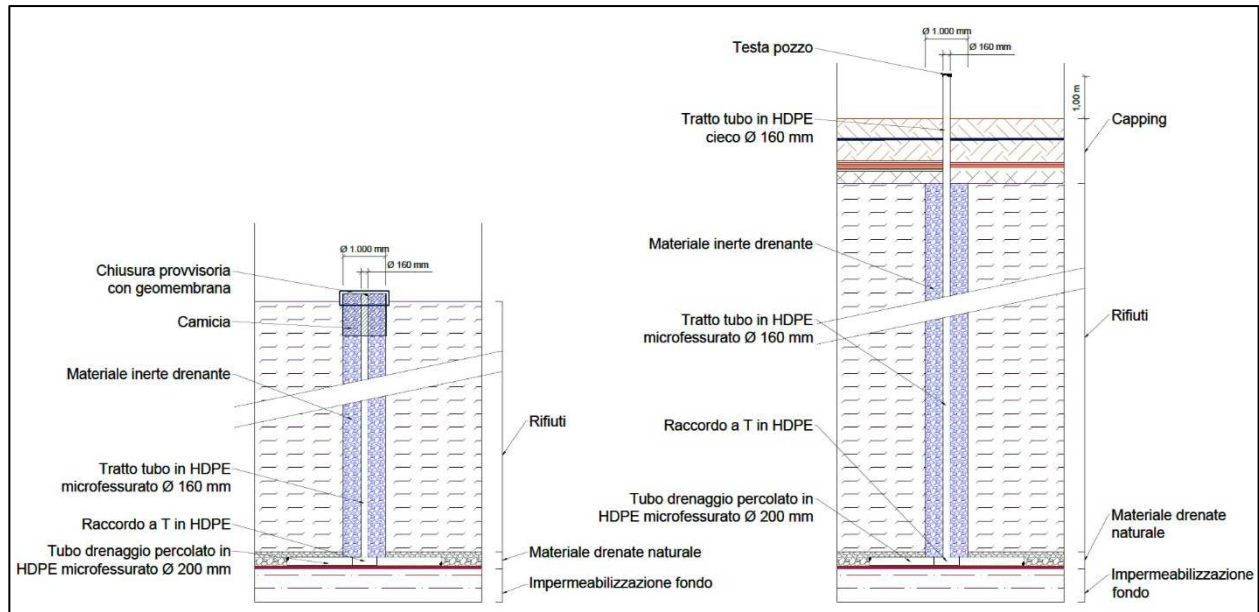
/XXIV: Schema pozzo estrazione biogas
